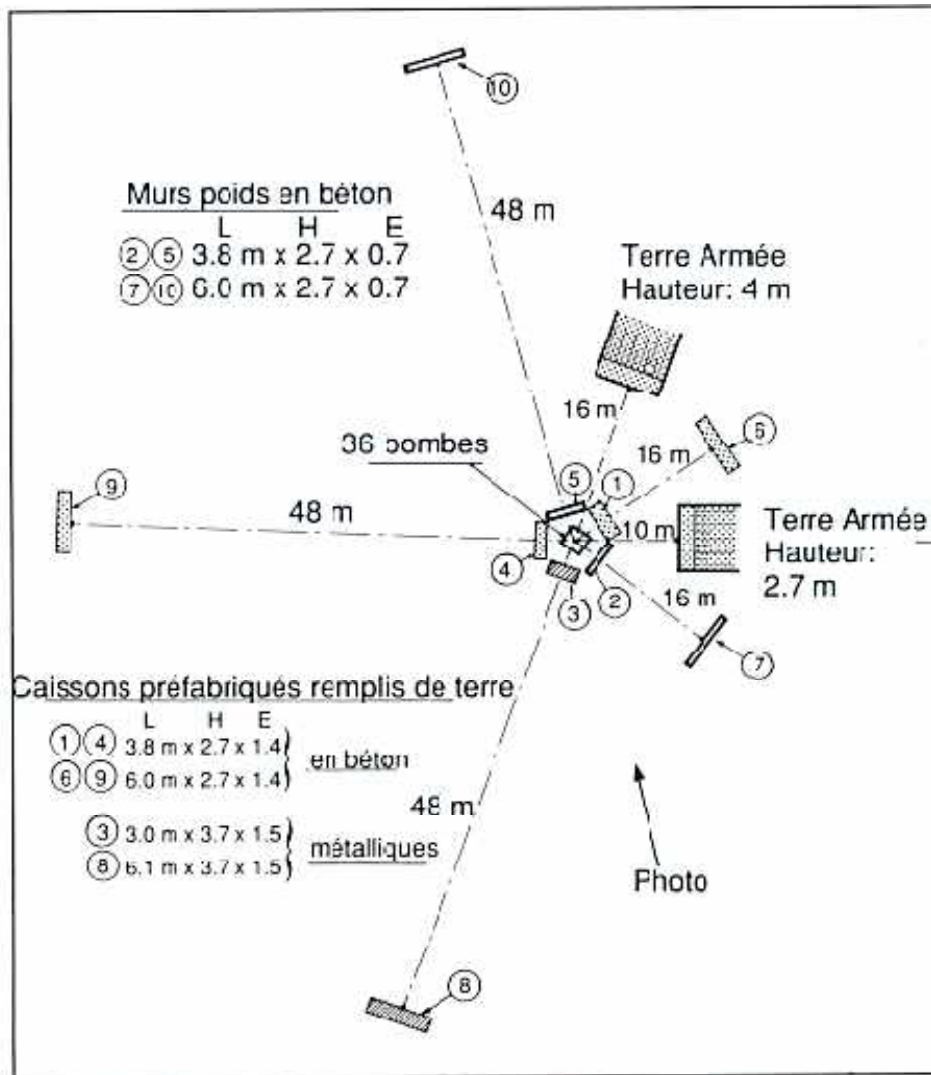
Plan du dispositif d'essai de Woomera [TER 05].
